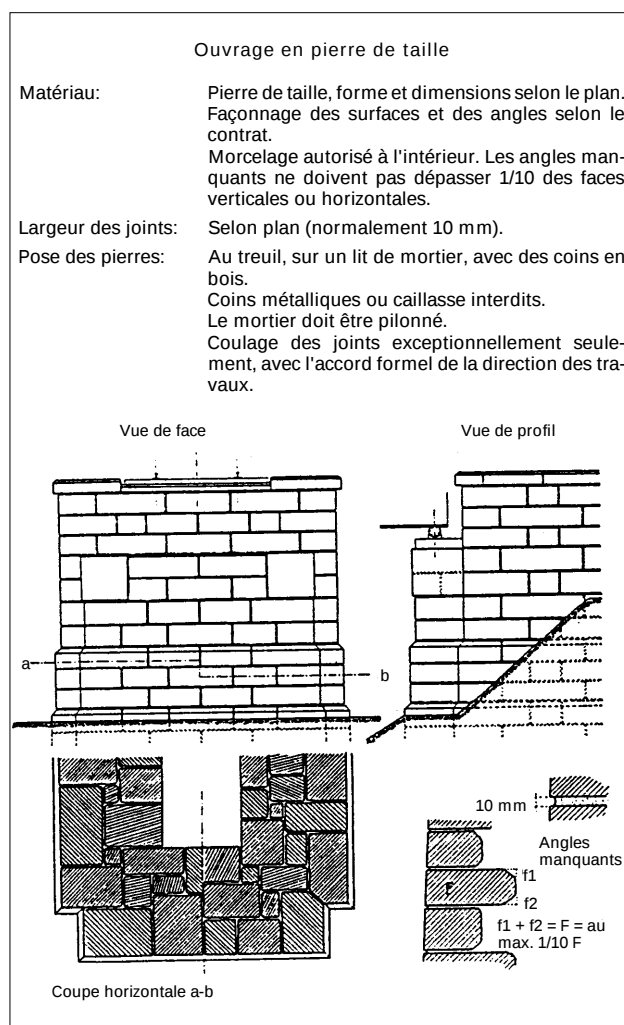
ouvrage en pierre de taille, selon [7.10]
